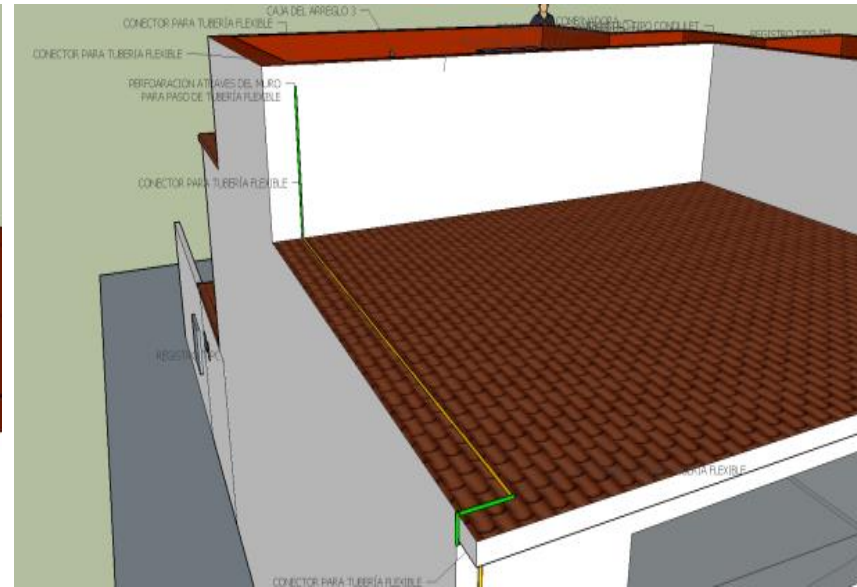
Plano 3D de ruta de tubería, vista 4: aporte propio.
